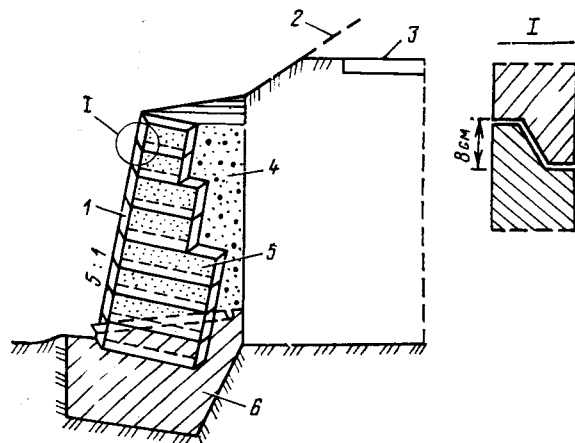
Подпорная стена из сборных бездонных ящиков: 1 — сборные железобетонные ящики; 2 — откос (в случае выемки); 3 — дорожная одежда (в случае насыпи); 4 — дренажный материал; 5 — грунтовый заполнитель; 6 — монолитный бетон фундамента
